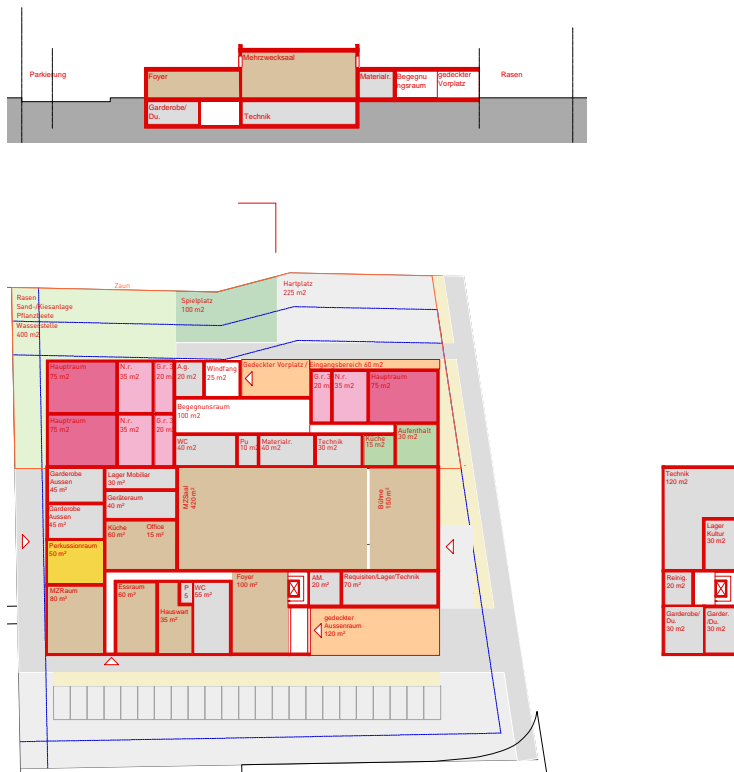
Schemaplan und Schemaschnitt Kindergarten und Mehrzweckgebäude kombiniert
